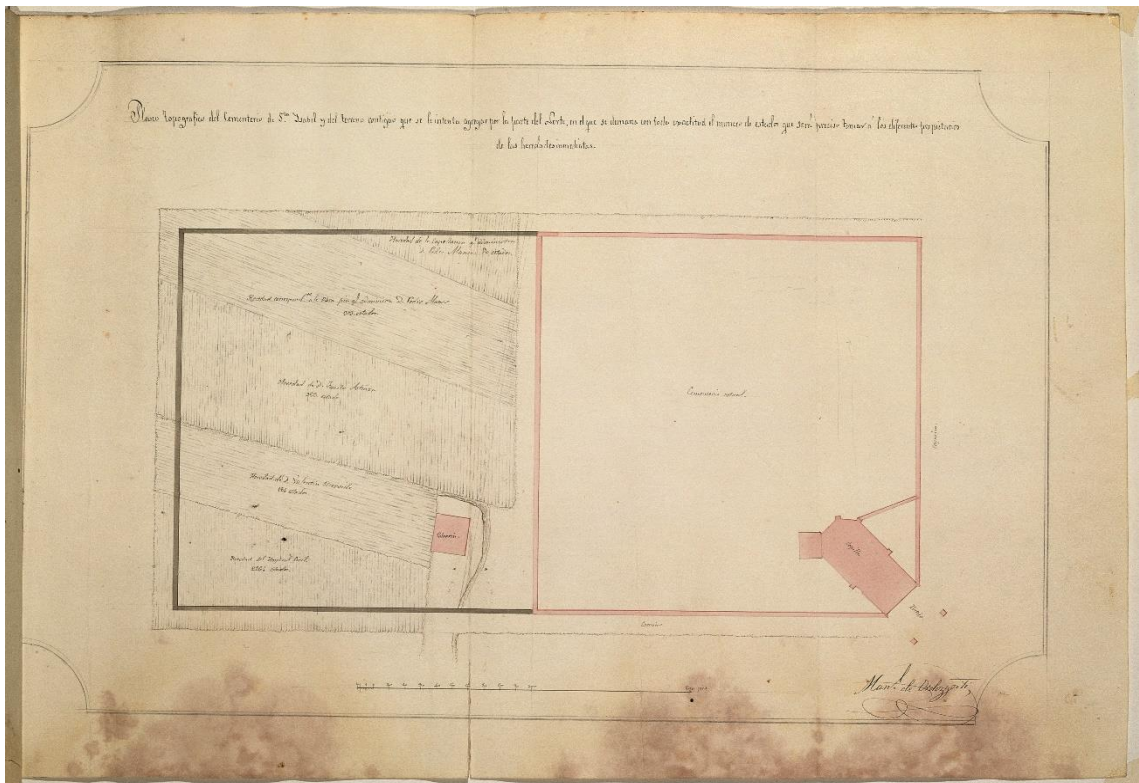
Plano topográfico del cementerio de santa Isabel realizado en 1848
